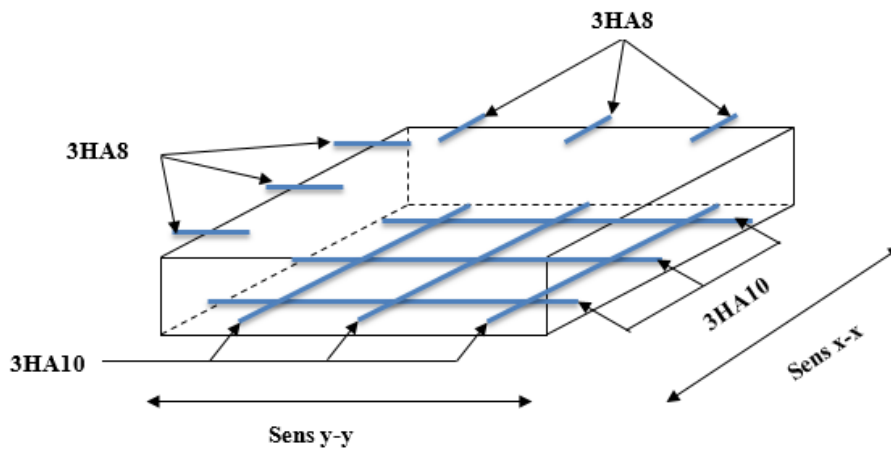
Schéma de Ferrailage de la dalle pleine du local machinerie
